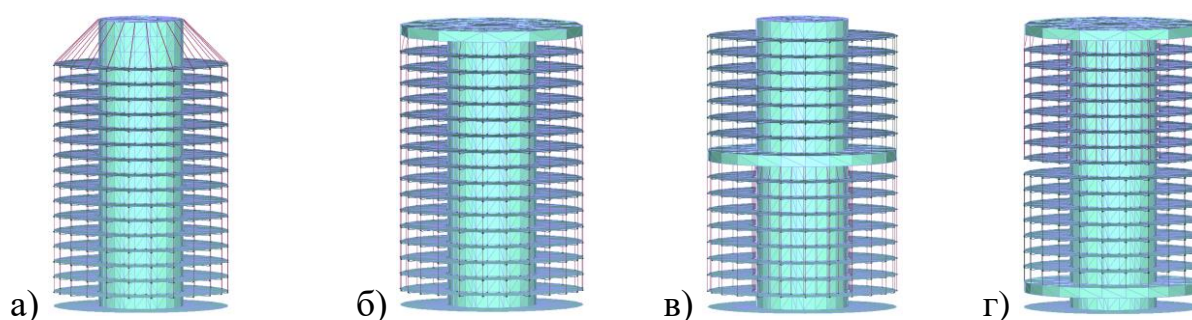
Расчётная модель здания консольно-подвесного типа с: а) первой расчётной схемой; б) второй расчётной схемой; в) третьей расчётной схемой; г) четвёртой расчётной схемой
